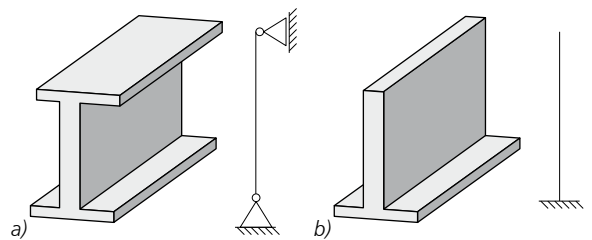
Statische Systeme Stahlbeton-Kellerwand
